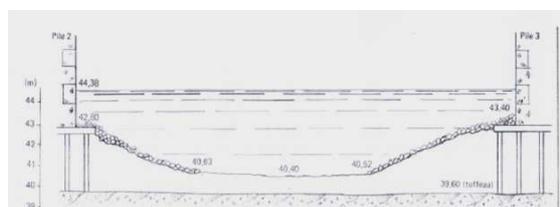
Le niveau de la passe entre les niveaux 2 et 3 n'est situé qu'à 0,8 m au-dessus du calcaire, mais à 2 à 3 m en-dessous des platelages des deux piles.
